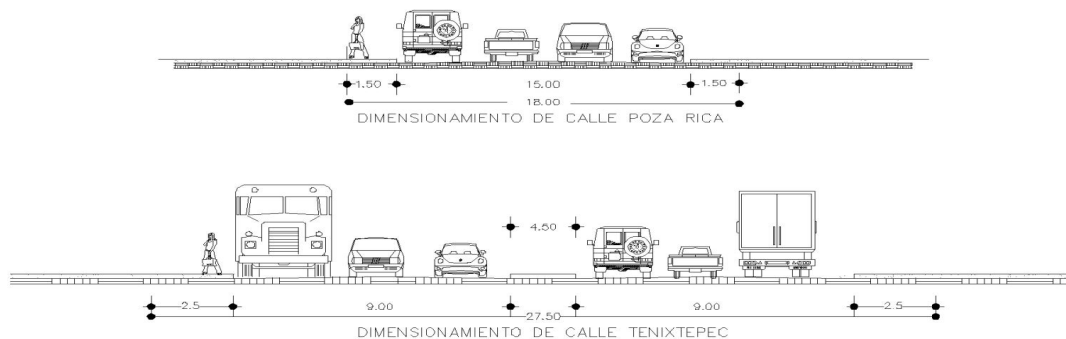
Dimensionamiento de las vialidades aledañas al terreno. Fuente: Elaborado por el autor
